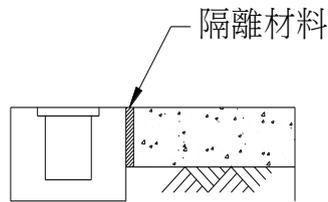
水泥混凝土鋪面版與結構物間設置隔離材料。
